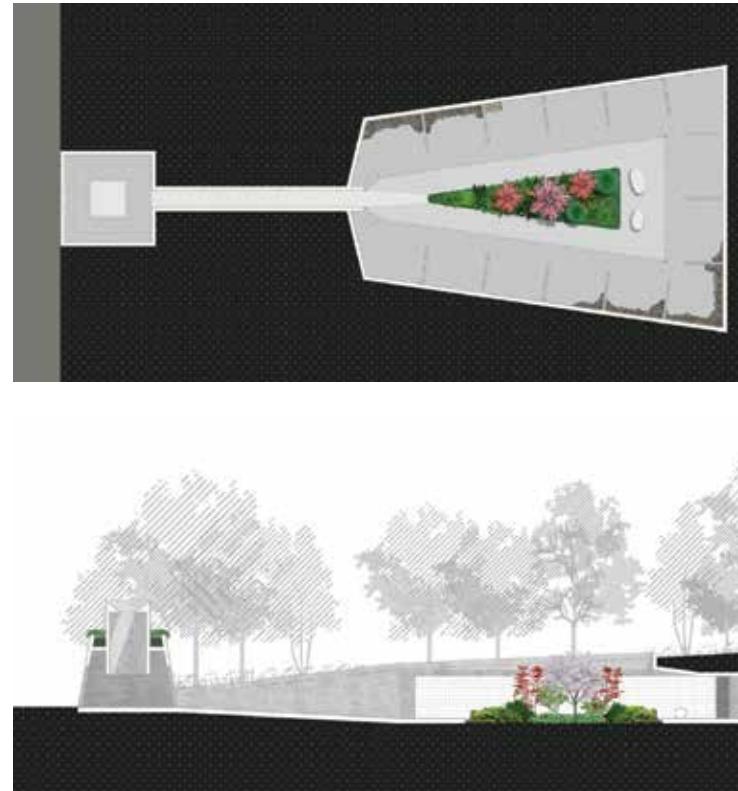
Grundriss und Schnitt des geplanten Ossariums, Stand 2018 (Florian Hertweck, studio hertweck – architecture + urban design, Differdingen, Luxemburg).
